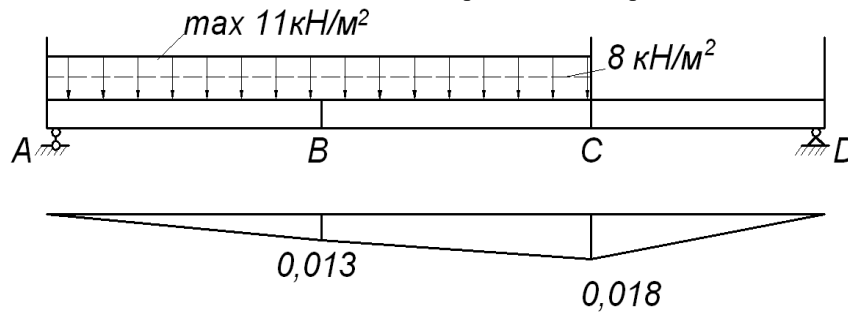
Характер деформирования фрагмента перекрытия при нагружении по схеме 2.
